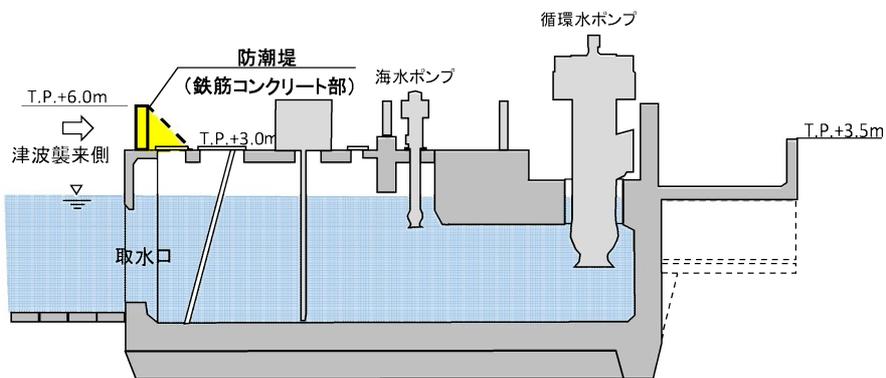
鉄筋コンクリート部 断面図(A-A 断面)
